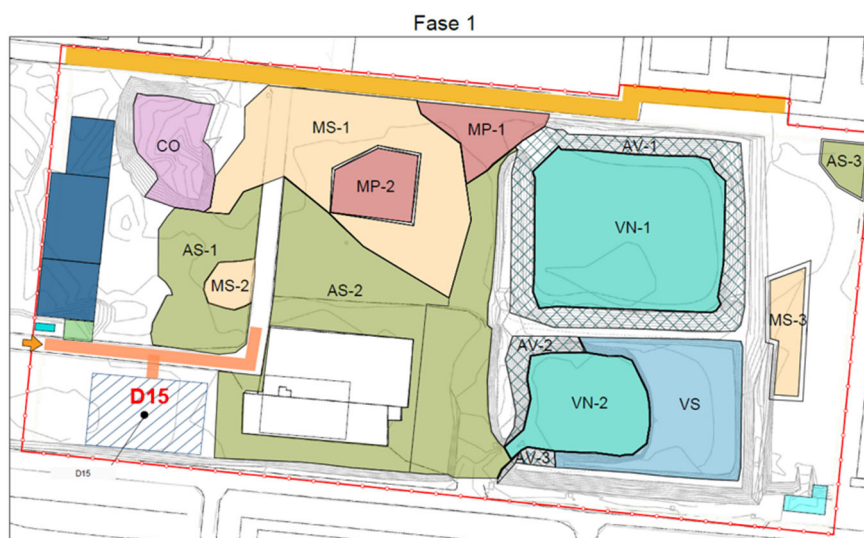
Planimetria area palte con individuazione delle zone di scavo e del deposito preliminare D15.
